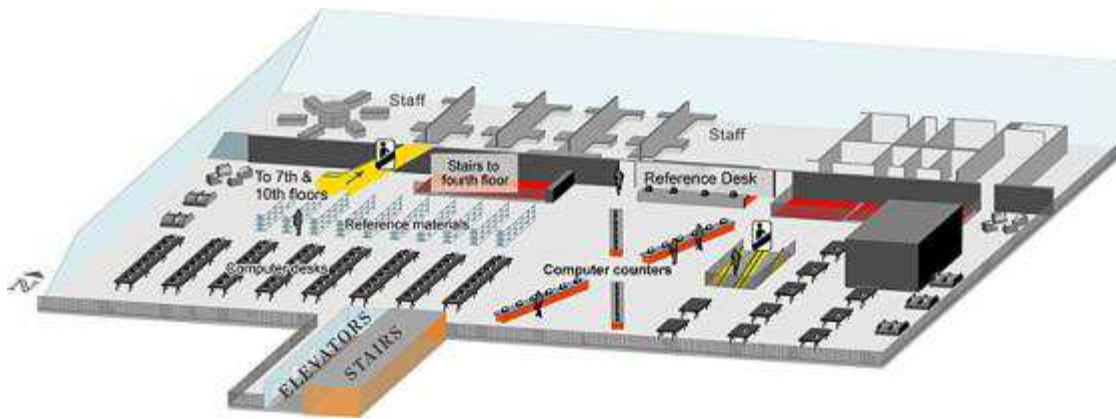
Seattle Public Library, Mixing Chamber, Plan.
